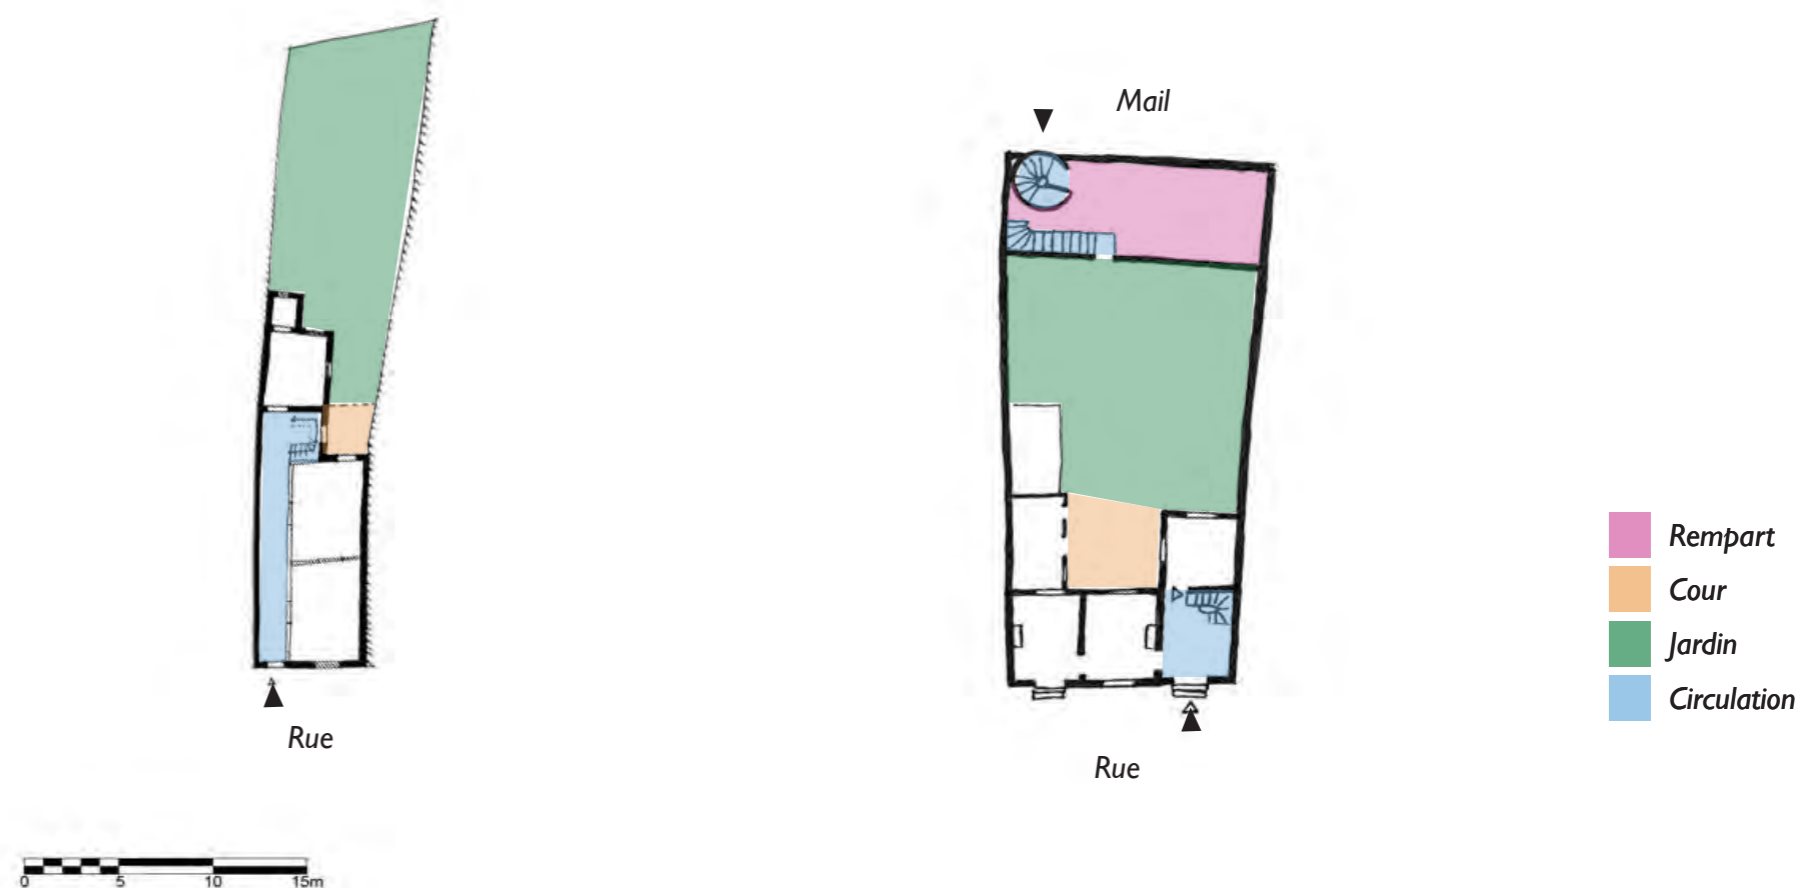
Plans rez-de-chaussée des maisons de ville sans porche
